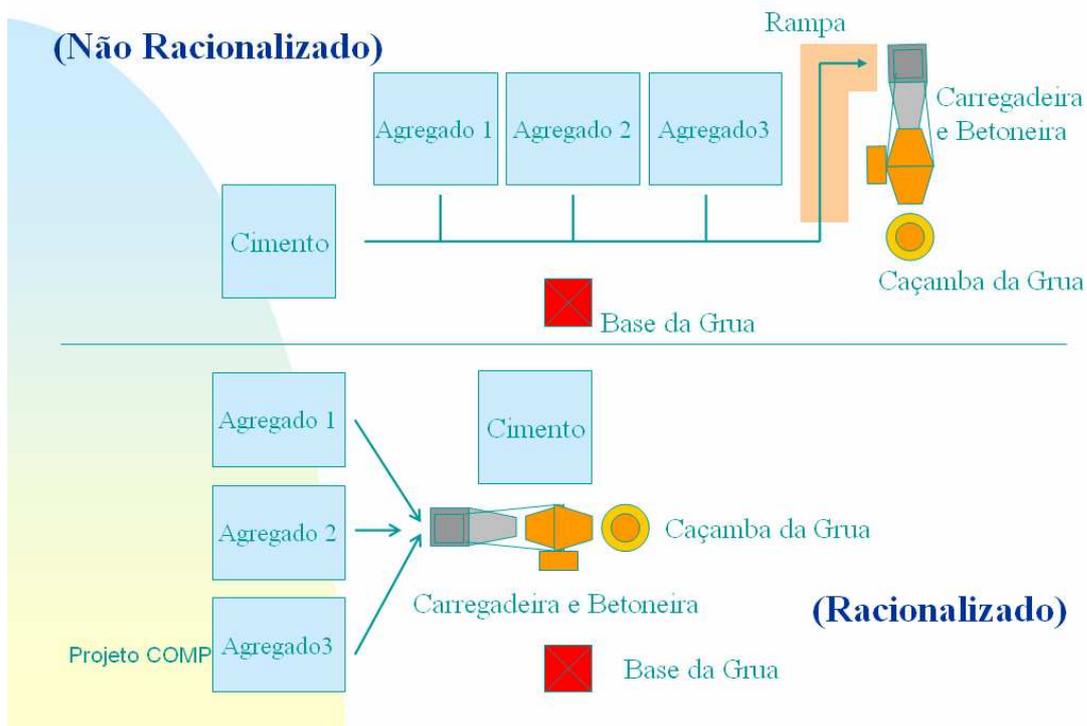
LEIAUTE FABRICAÇÃO DE CONCRETO EM OBRA (PRINCÍPIO 1)
